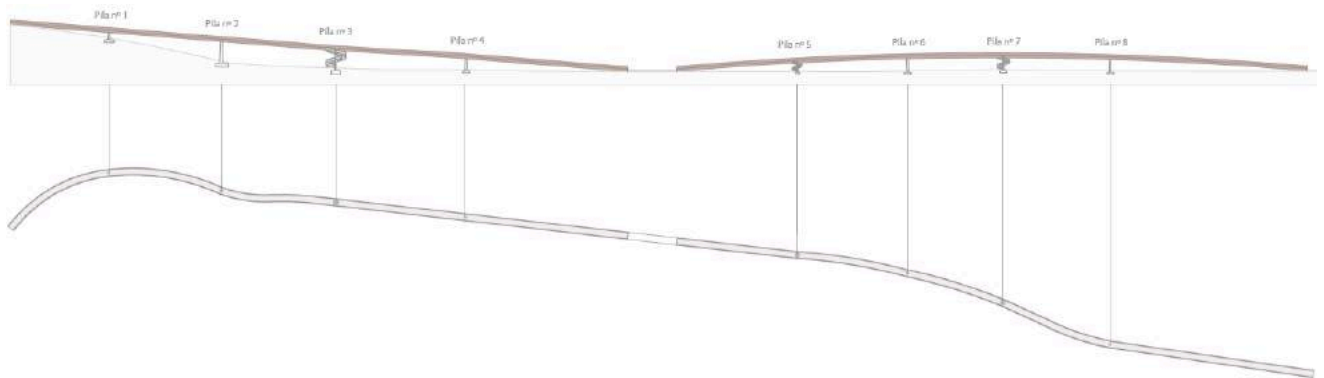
Recorte del plano “Ubicación de las pilas de la pasarela en perfil longitudinal y en la planta”
